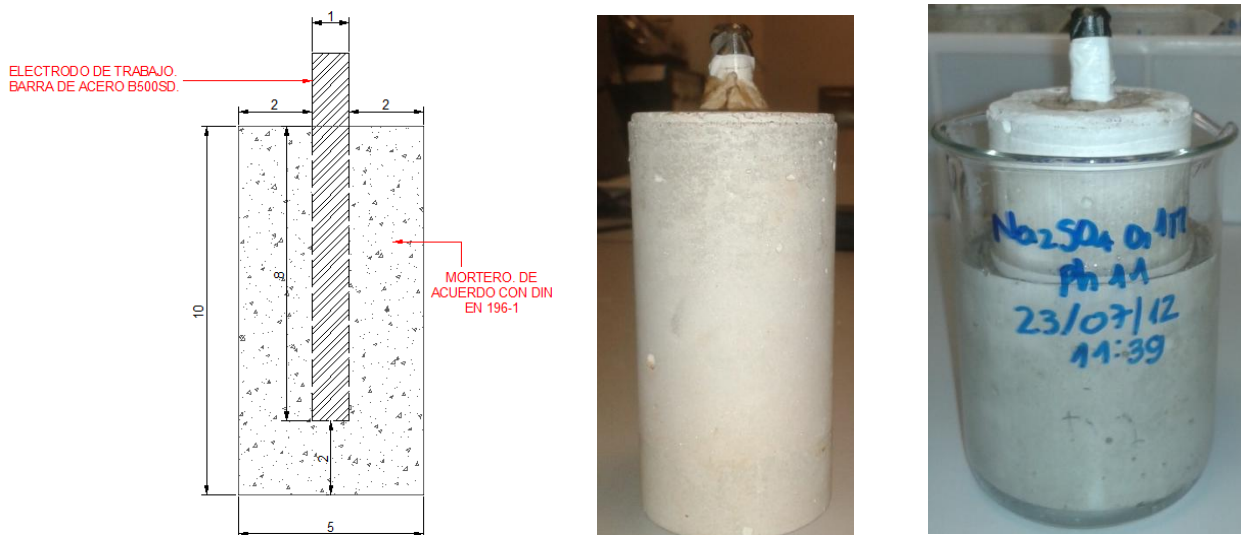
Probetas de hormigón armado. Fuente: Elaboración propia.
